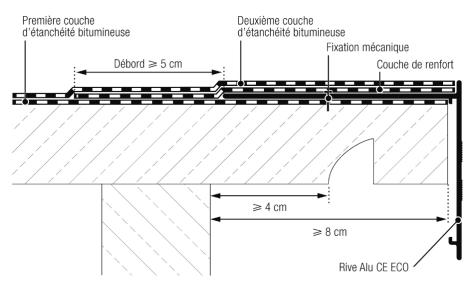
Bande de rive dans le cas d'une étanchéité bicouche bitumineuse
